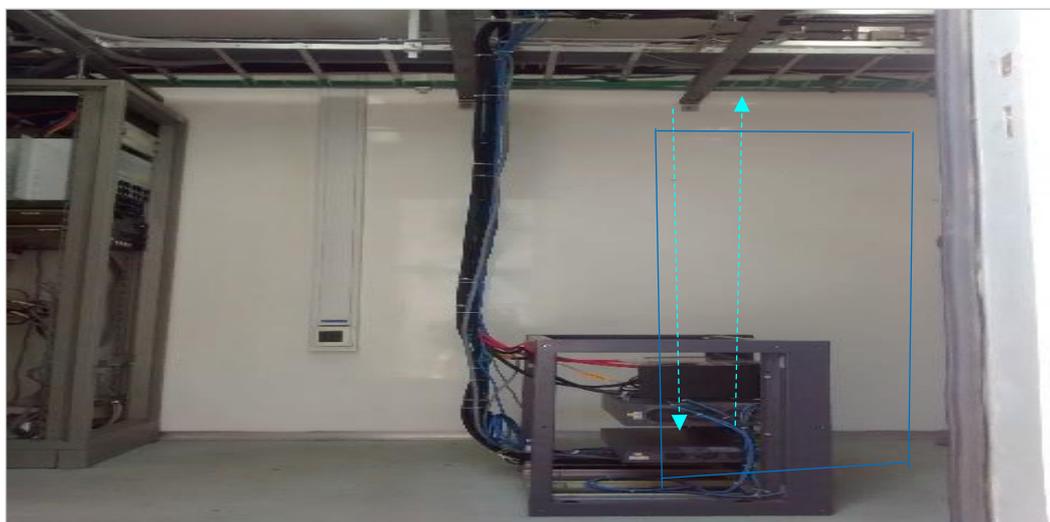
Ubicación de ODF proyectado Site Amauta
